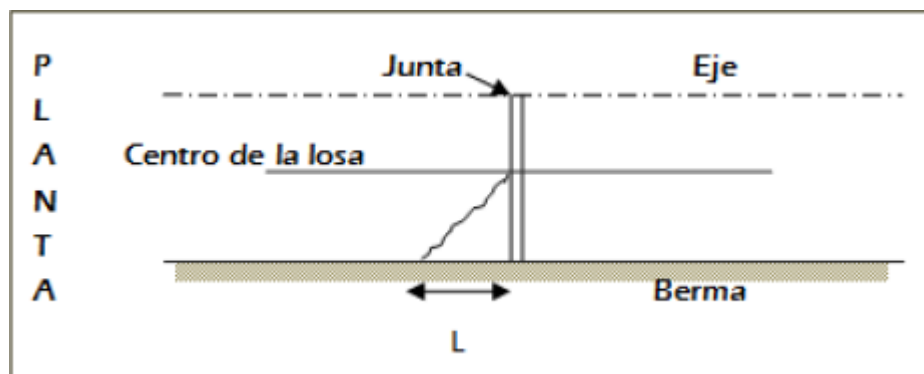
Esquema de la vista en planta de una grieta de esquina.
